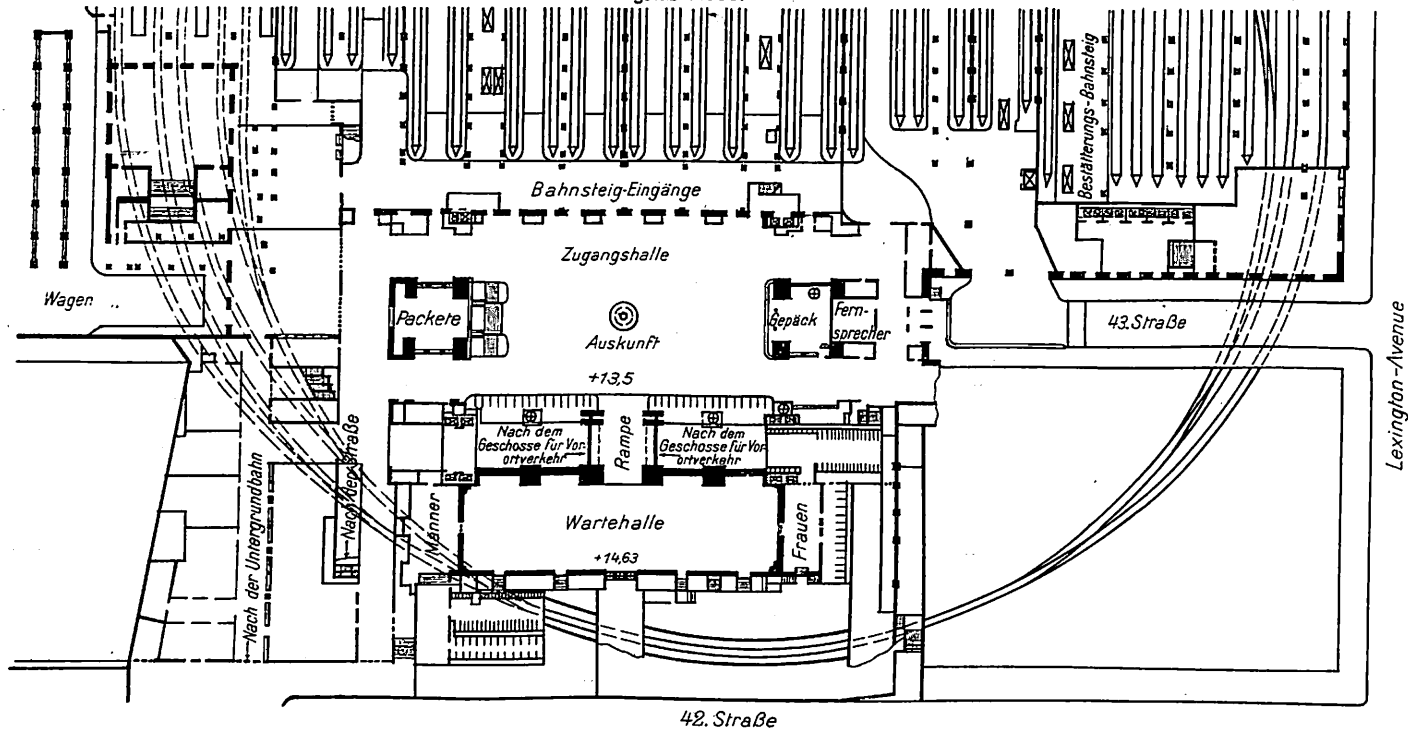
Grundriß in Höhe der Zugangshalle für Vorortverkehr.
